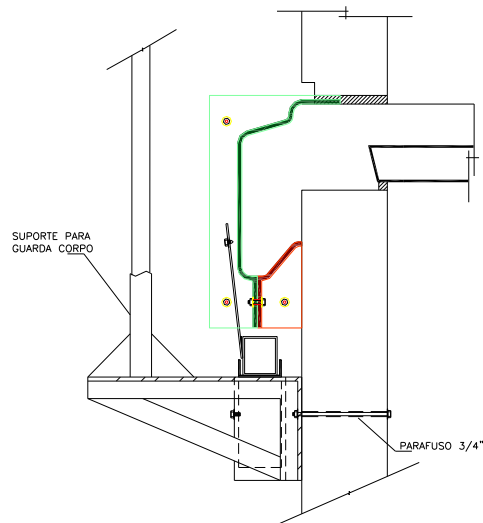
Desenho esquemático a fôrma metálica para construção da gola
